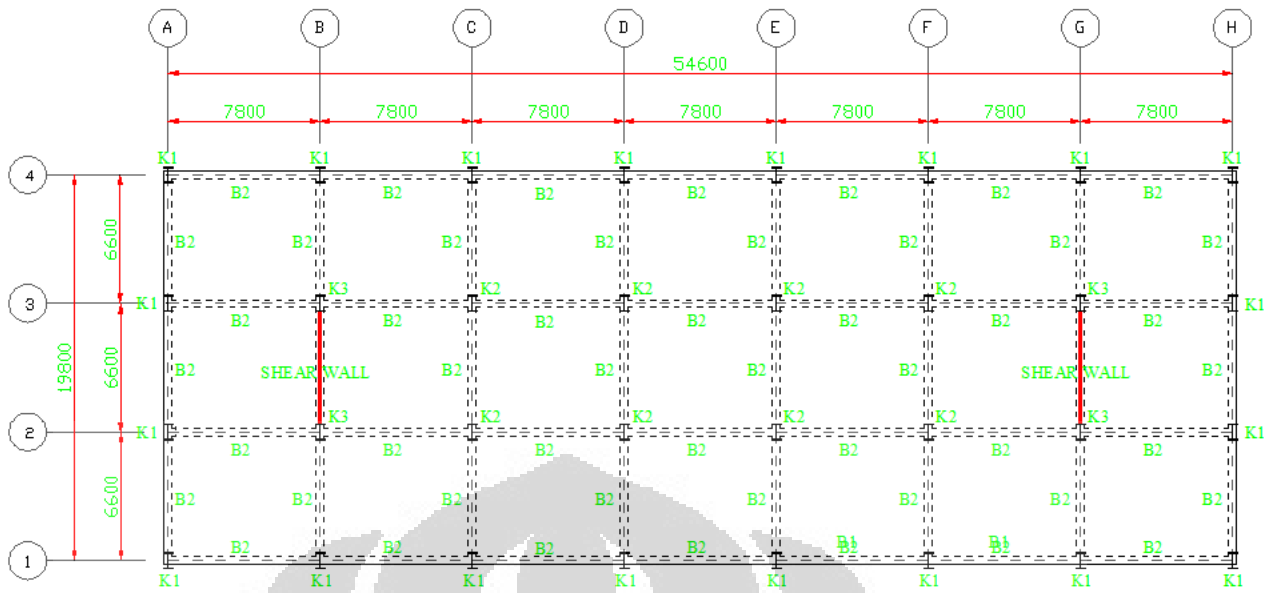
Denah Struktur Beton Lantai 9-12
